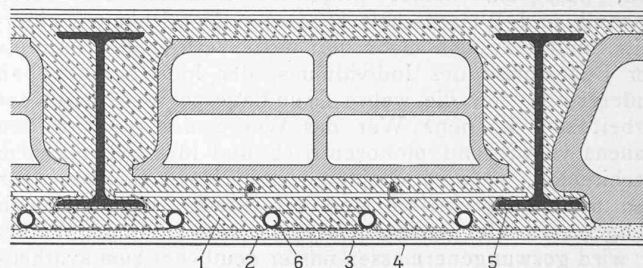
Deckenquerschnitt mit Panelheizung. 1 Beton, 2 erster Verputz rd. 8 mm stark, 3 zweiter Verputz rd. 6 mm, mit Ruffeneinlage 4, 5 Streckmetall, 6 Heizrohr.
